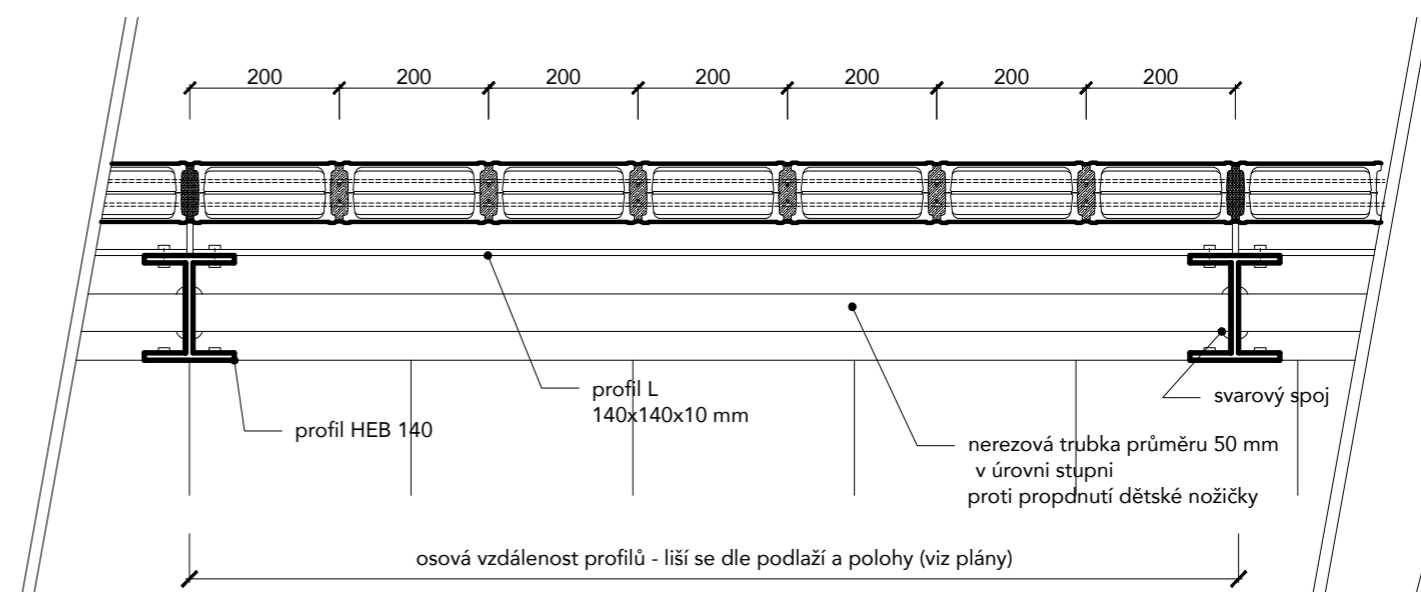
KONSTRUKČNÍ DETAIL LUXFEROVÉHO PLÁŠTĚ
